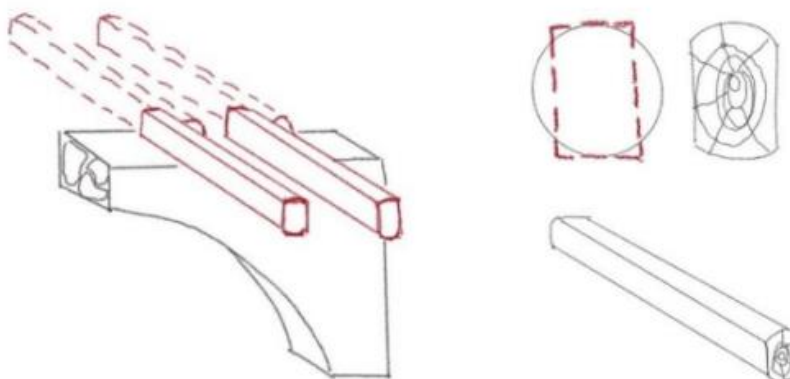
Esquema vigas de madera y su disposición. Elaboración propia
